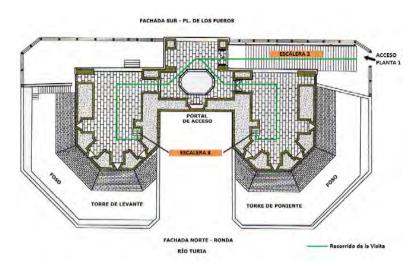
Sección de la primera planta y recorrido (Fuente: www.jdiezarnal.com Plano modificado por el autor)
